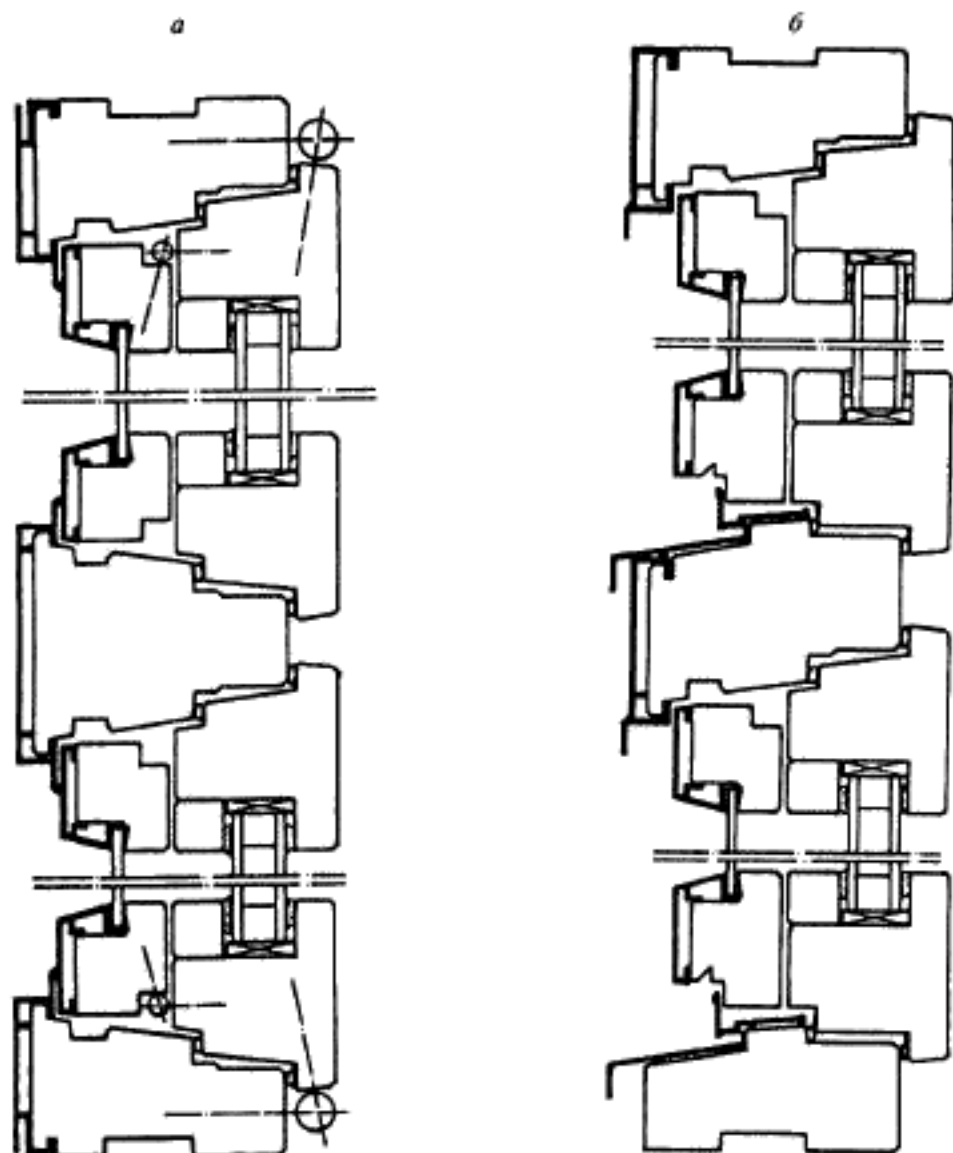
Примеры горизонтального (*а*) и вертикального (*б*) сечений оконного блока спаренной конструкции с алюминиевыми облицовочными профилями
